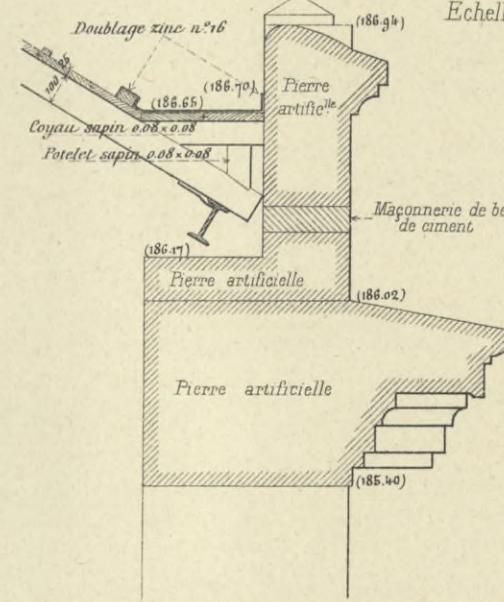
Coupe d'un gradin inférieur du chéneau de la façade amont.
